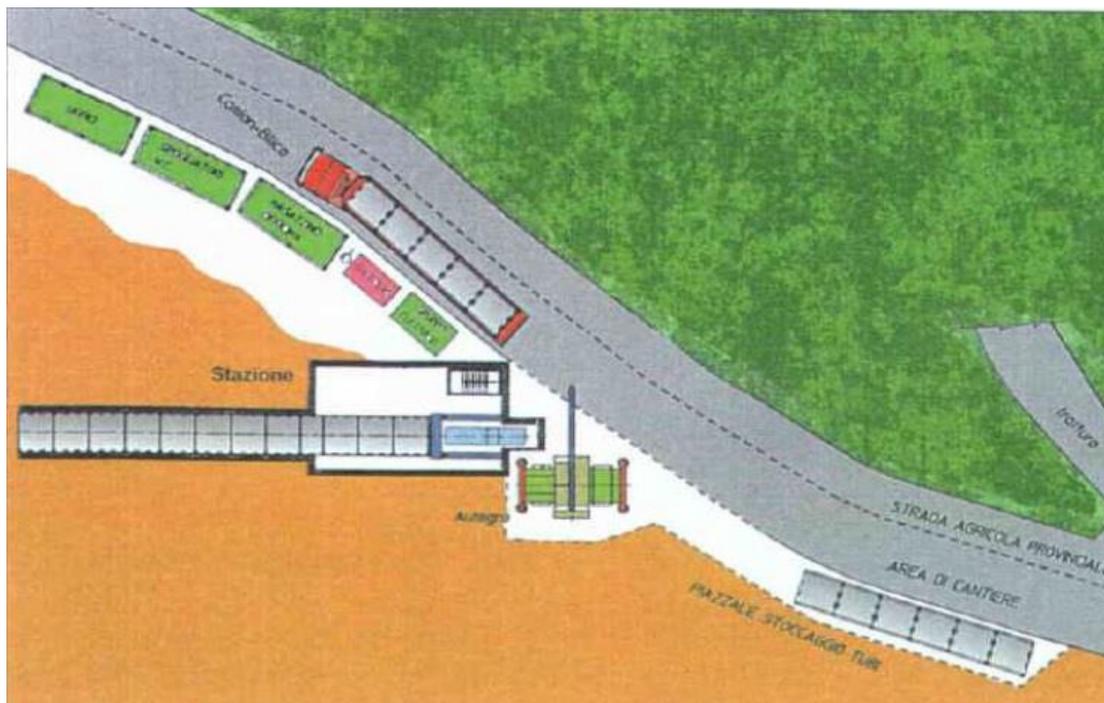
Schema tipo di un cantiere per l'installazione di un microtunnel
